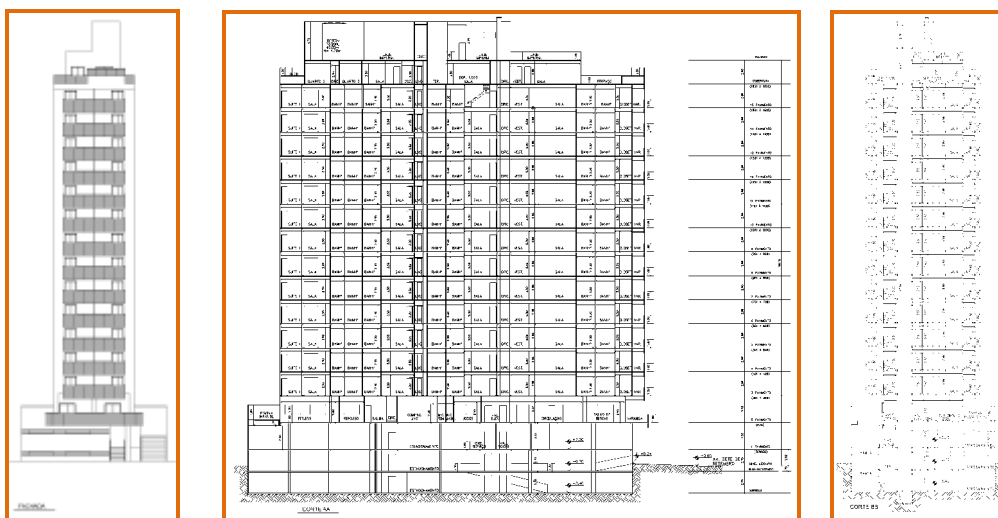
Cortes e Fachada - Fonte Projeto Legal
